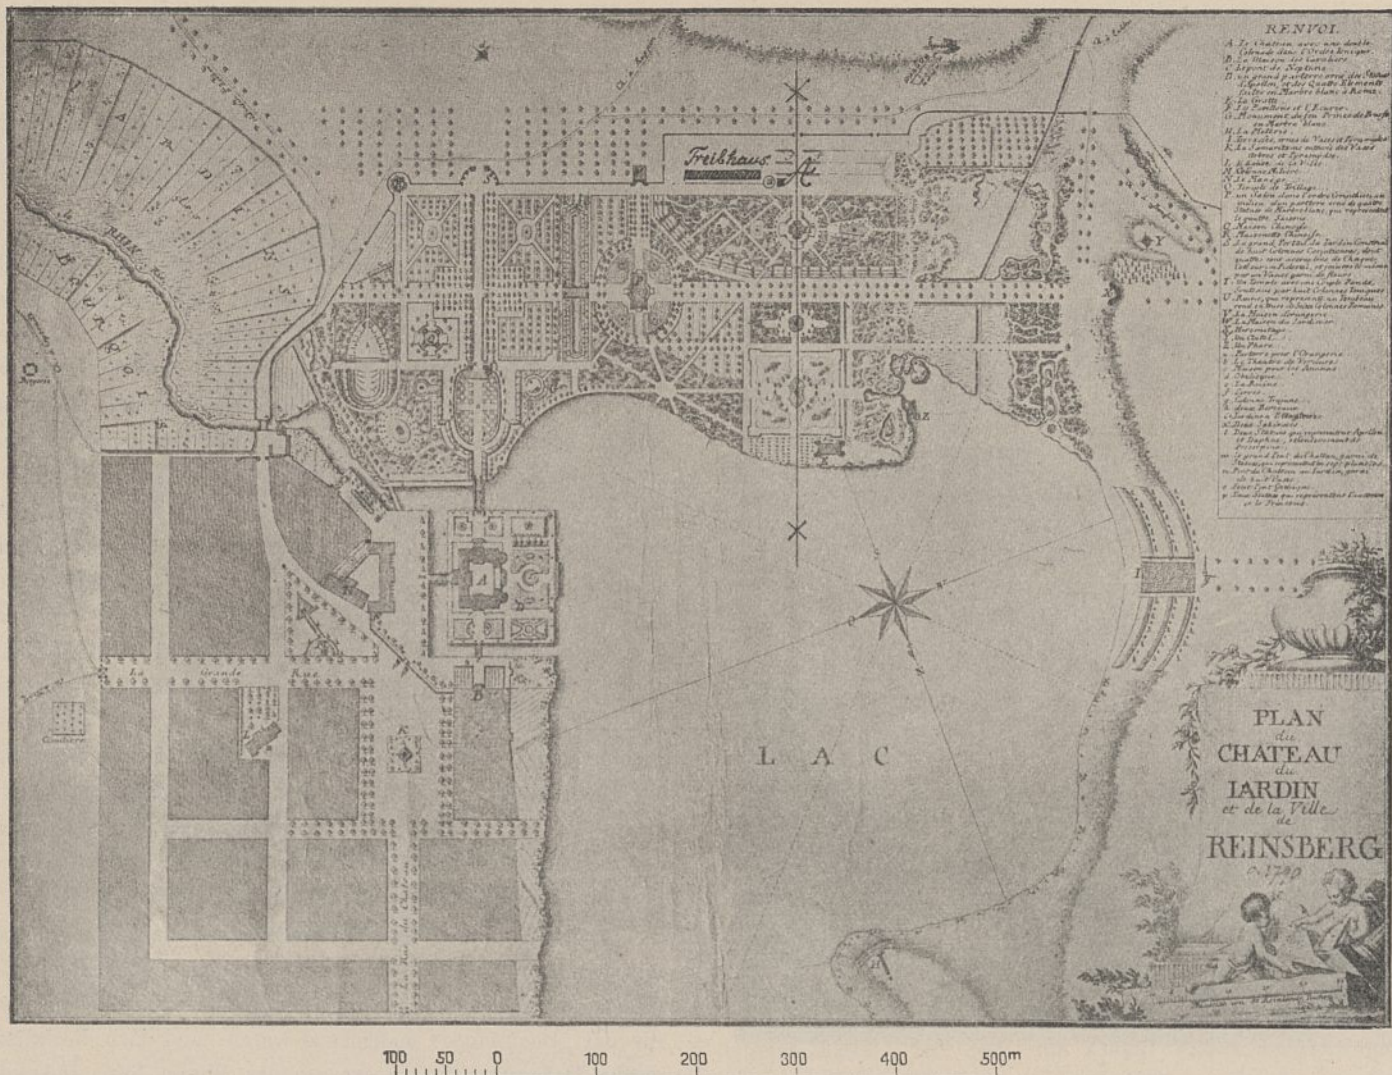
Schloß Rheinsberg. Lageplan des Schlosses (A) mit Umgegend.
